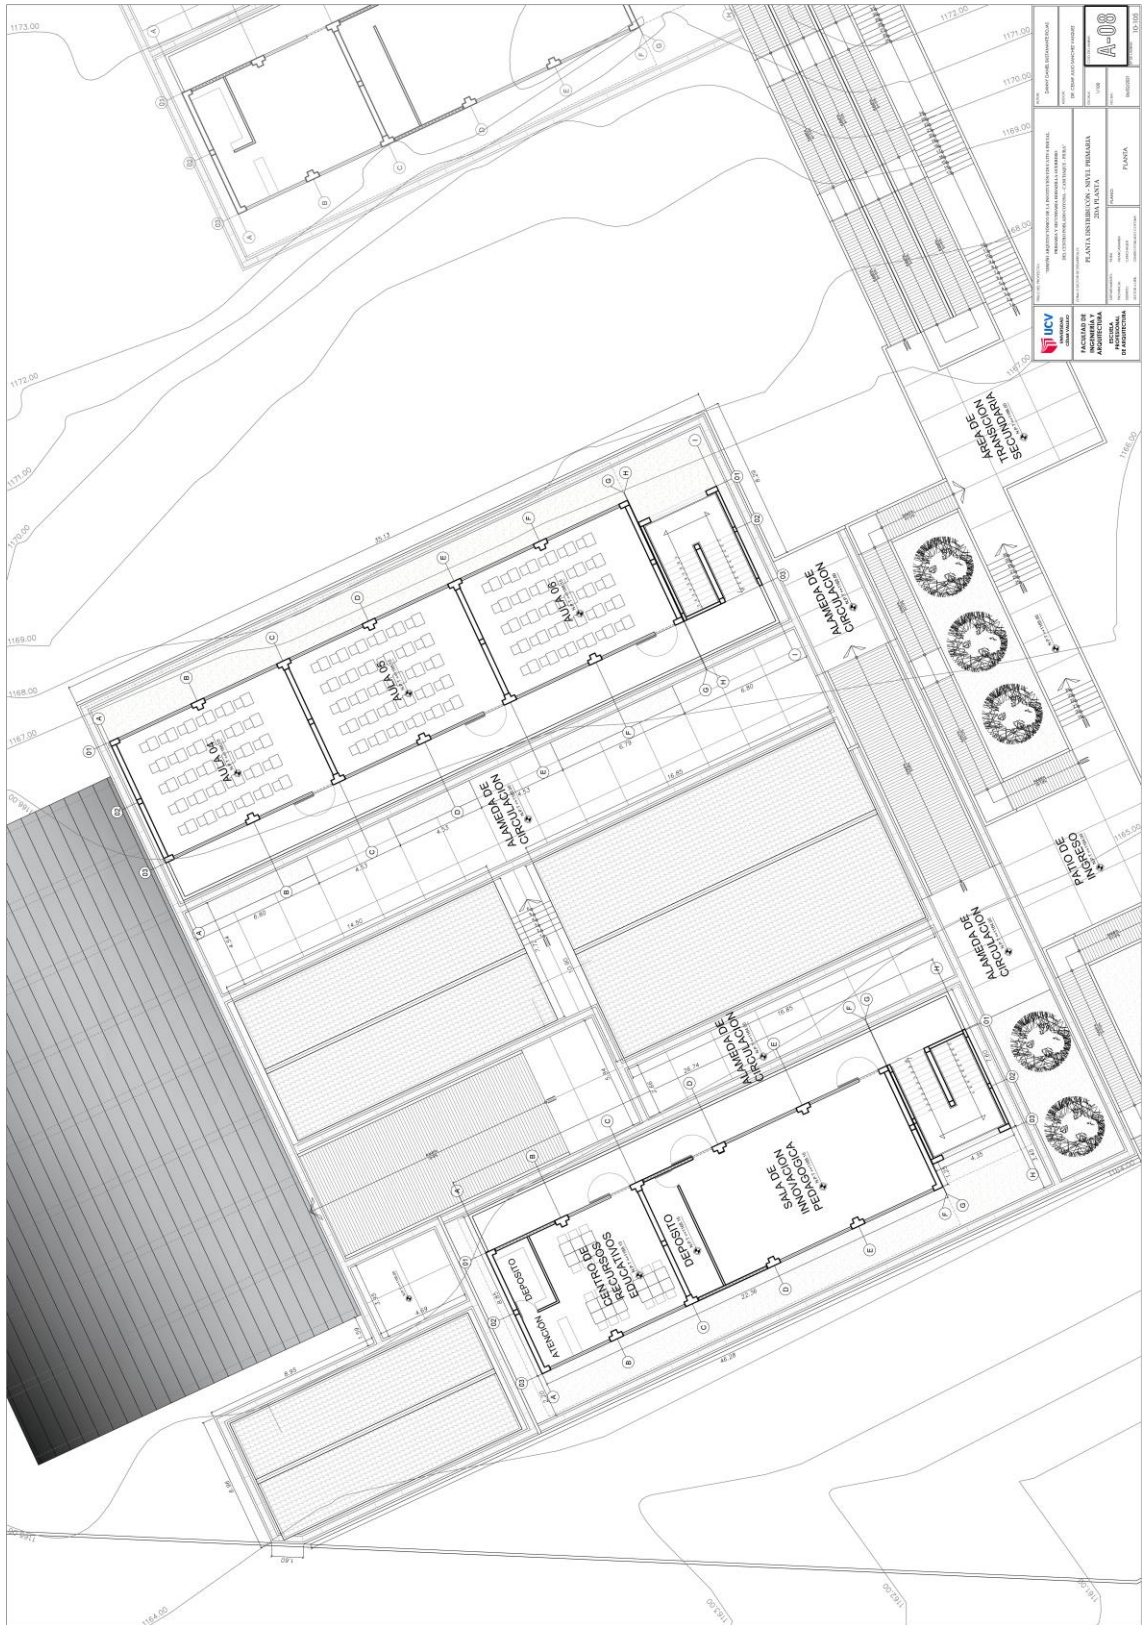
PLANO PLANTA NIVEL PRIMARIA 1ER NIVEL
